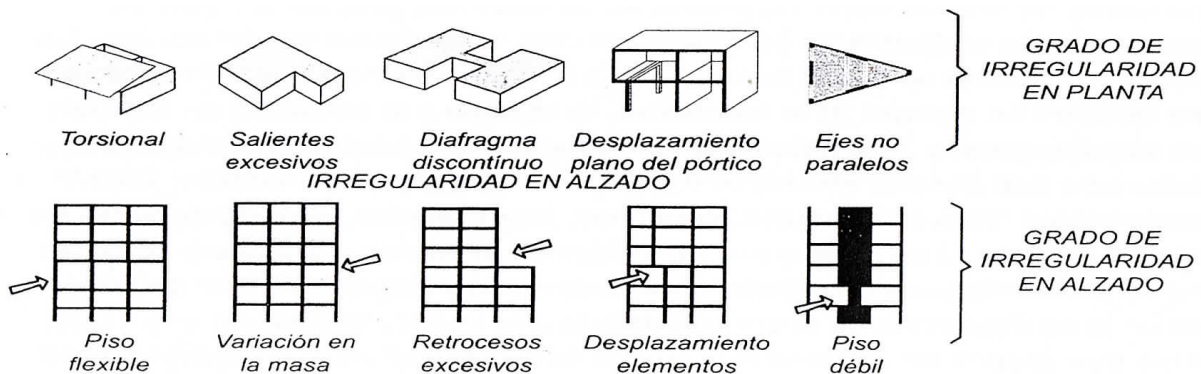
Irregularidad en Planta y Alzado. Fuente: Guevara, (2007), p. 111
